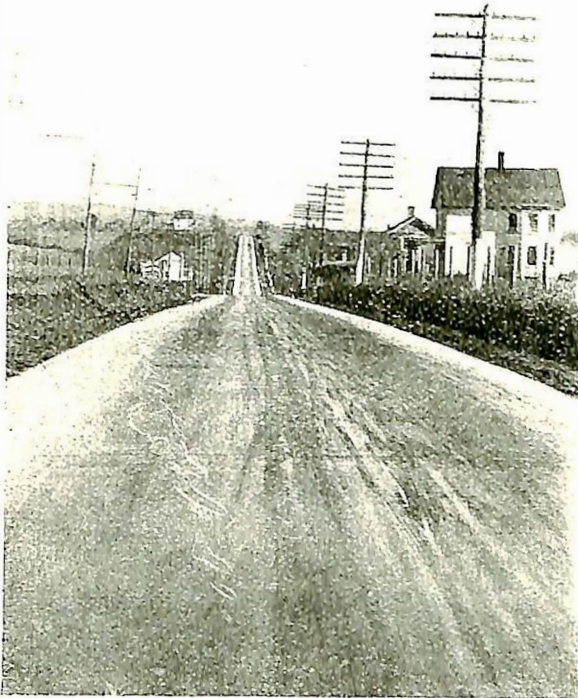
Betongvei Phillipsburg—Washington, New Jersey, bygget 1922.
